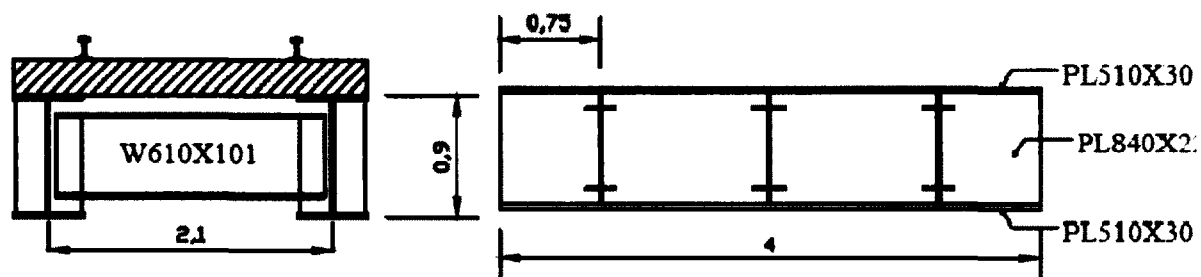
Pont bi-poutres - Section transversale et élévation - Section E
